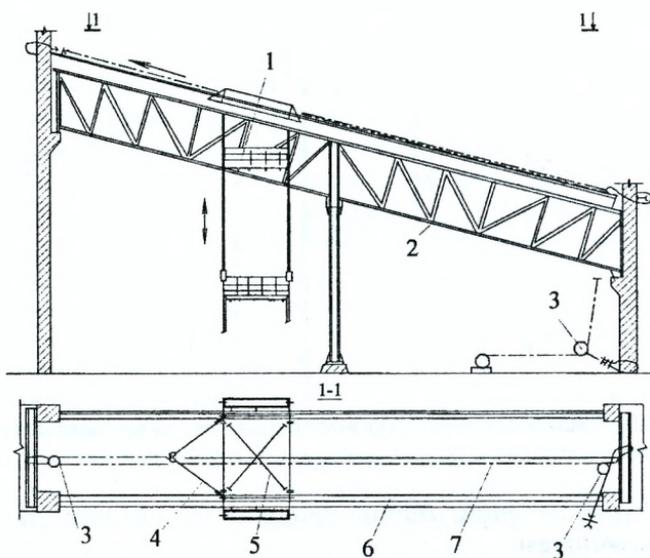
Усиление конструкций транспортной галереи дополнительными ненапрягаемыми элементами:
